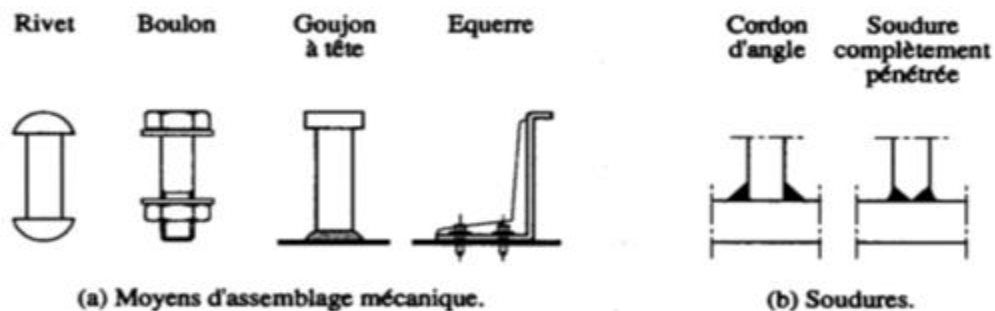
Moyens d'assemblage mécanique et soudures.
